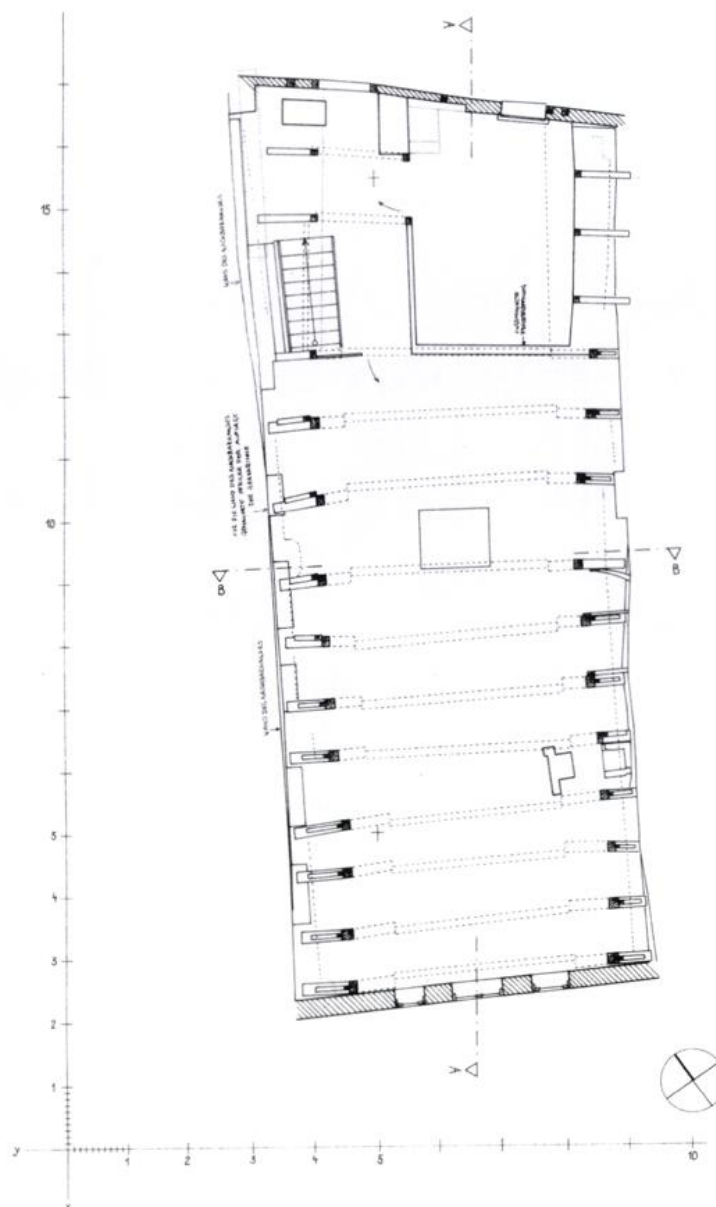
Grundriß Dachgeschoß Schnoor 14.
